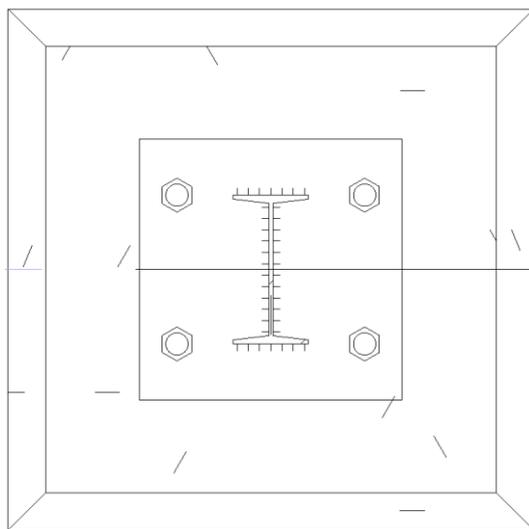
Пример нанесения обозначений сварки
